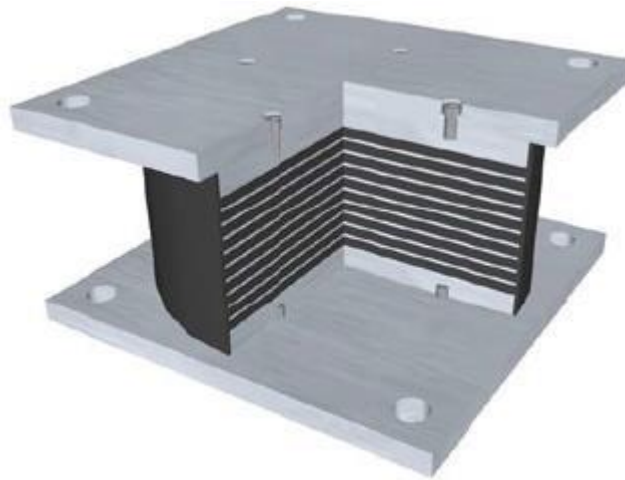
Aislador tipo High Damping Rubber Bearings.
